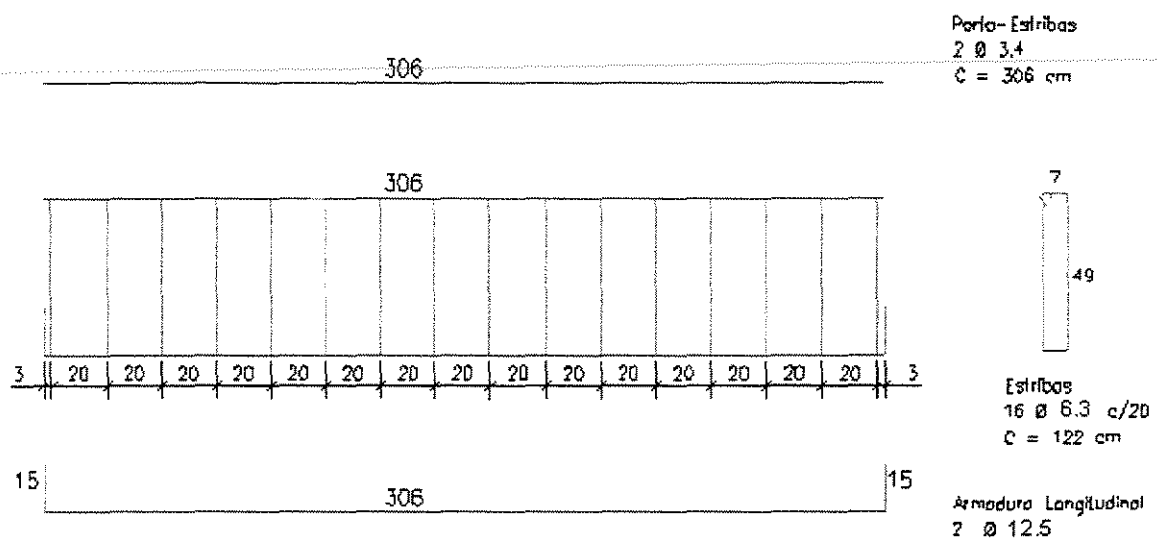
DETALHE DE ARMADURAS - VIGA 3BL-CIS
